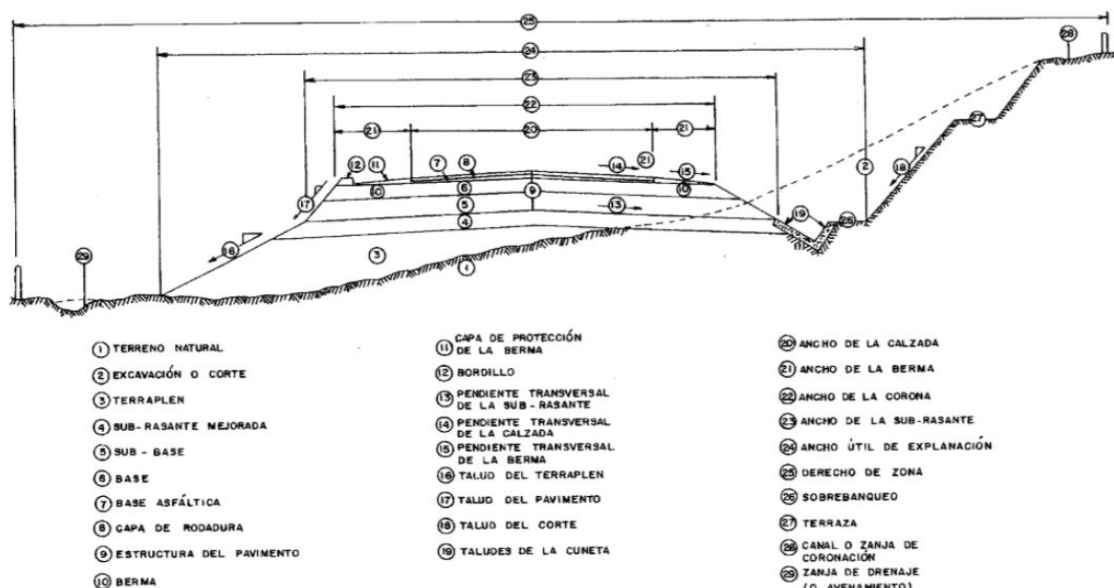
Sección típica de un pavimento flexible Fuente: Montejo Fonseca Alfonso, "Ingeniería de Pavimentos para Carreteras", pág.3.
